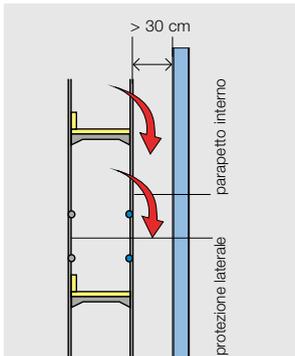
parapetto interno per la costruzione in carpenteria e con elementi prefabbricati.
